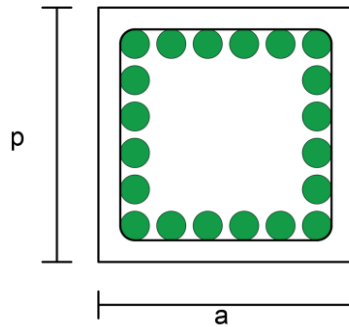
Sección de la Columna. Fuente: Nicolás Pozo
